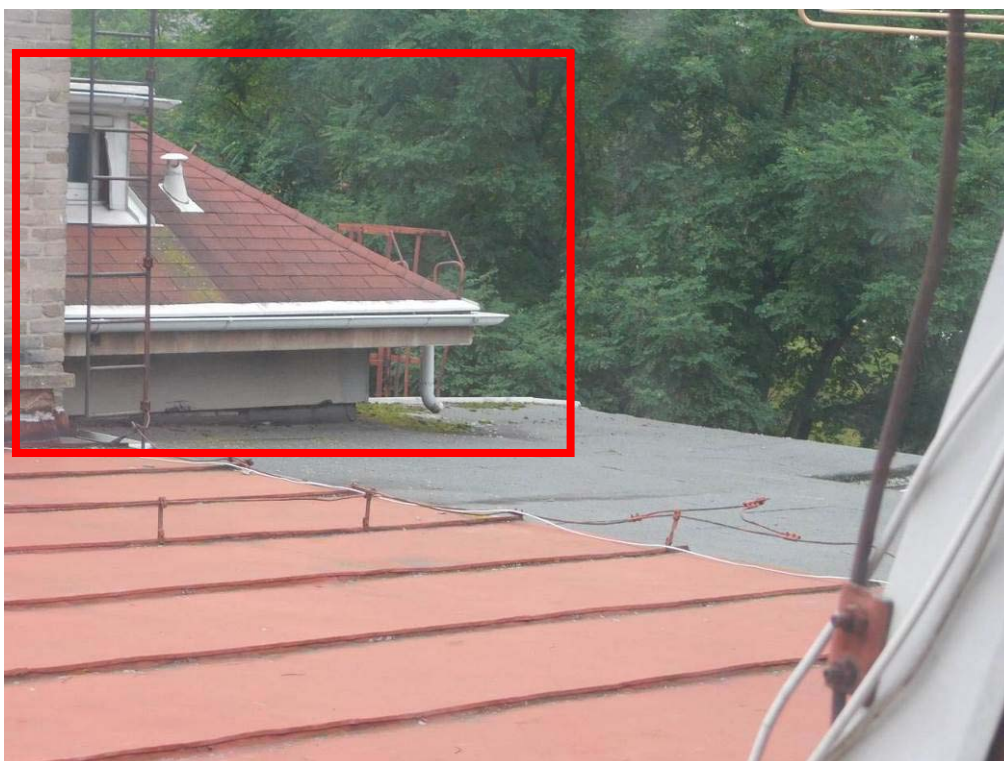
Celkový pohled na Z část objektu – vyznačena sledovaná část krovu
